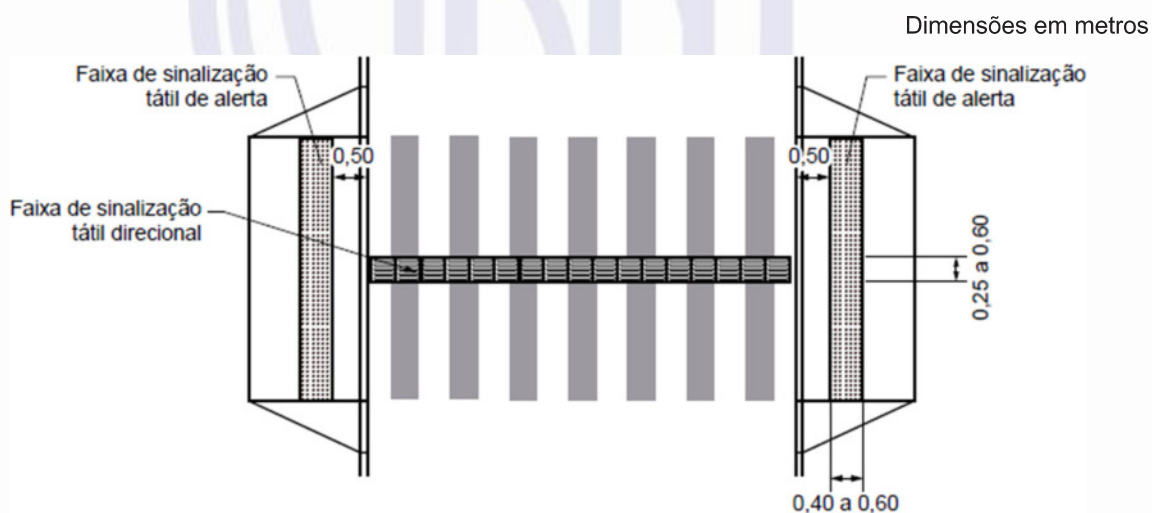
Travessia junto a rebaixamentos de calçada e com canteiro central
